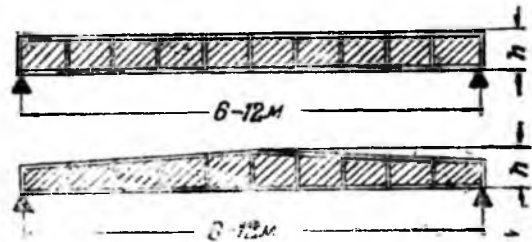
Деревянная двутавровая балка с перекрестной стенкой
